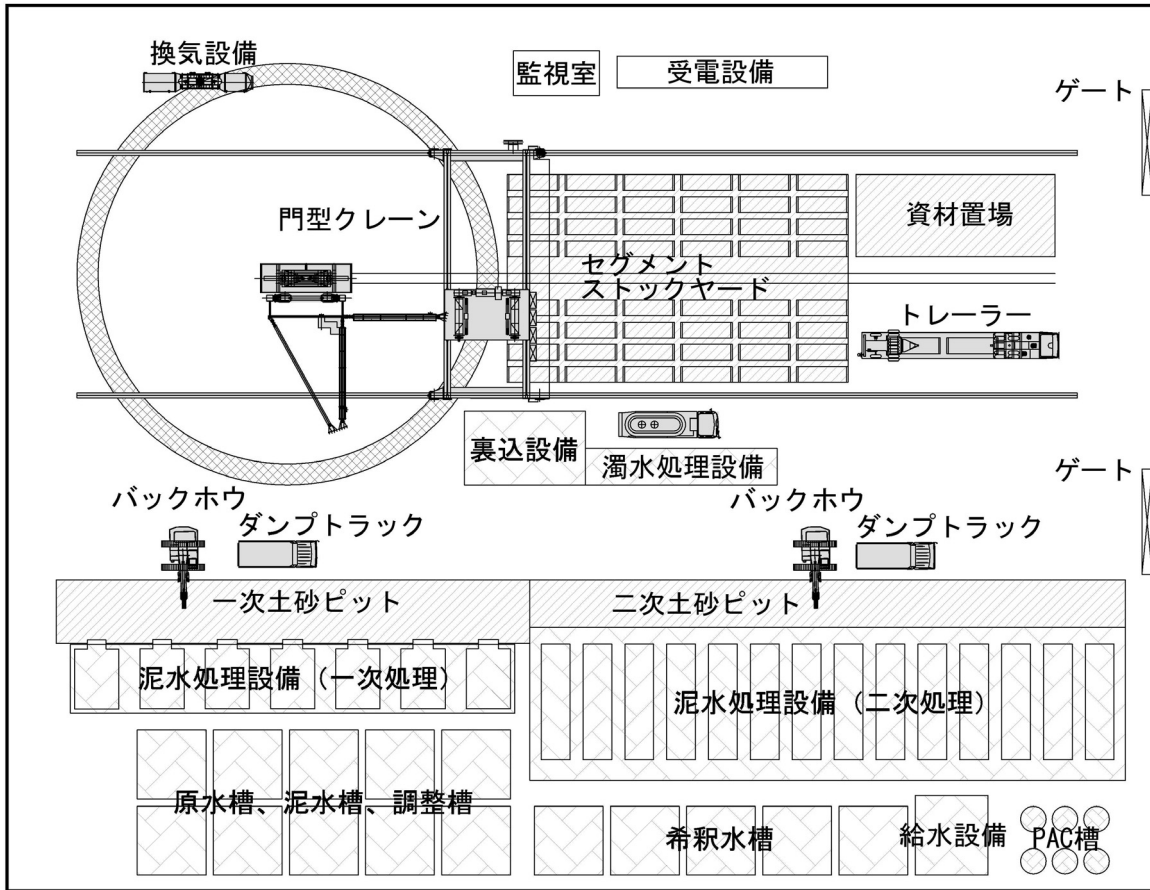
非常口の施工ヤードの概要（泥水式シールド工法によるトンネル施工時）
